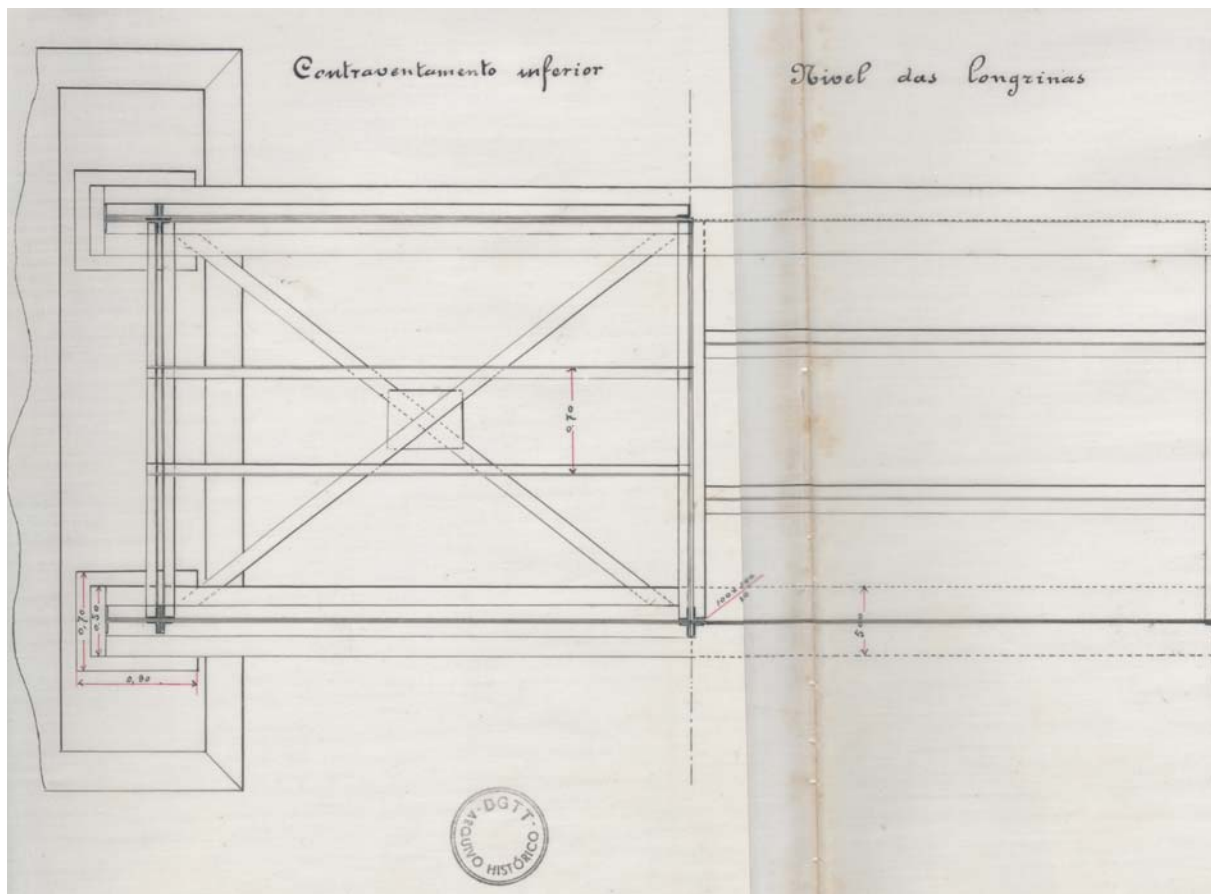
Ponte metálica com 35,0 m de vão – contraventamento inferior e nível das longrinas
